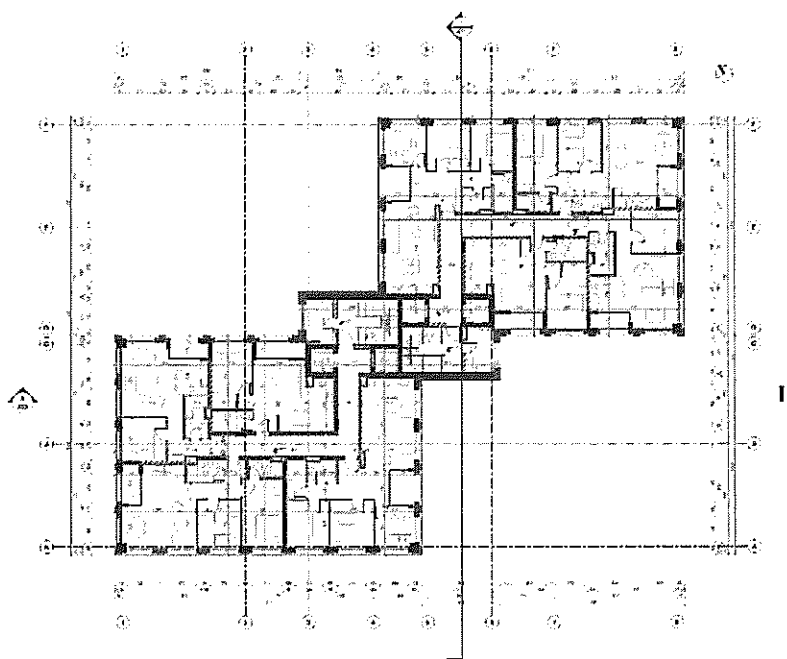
Planimetria e katit të njëmbëdhjetë
